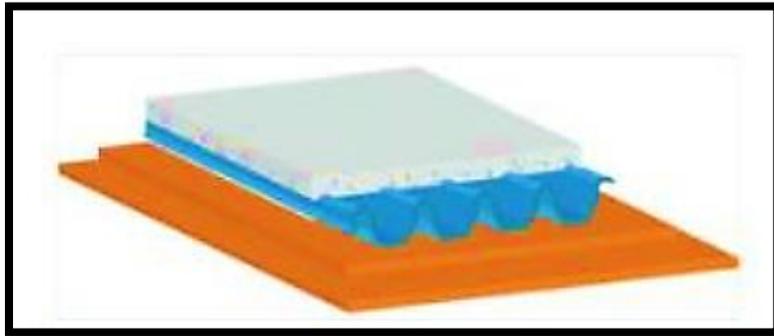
DALLE AVEC PLAFOND COUPE-FEU
